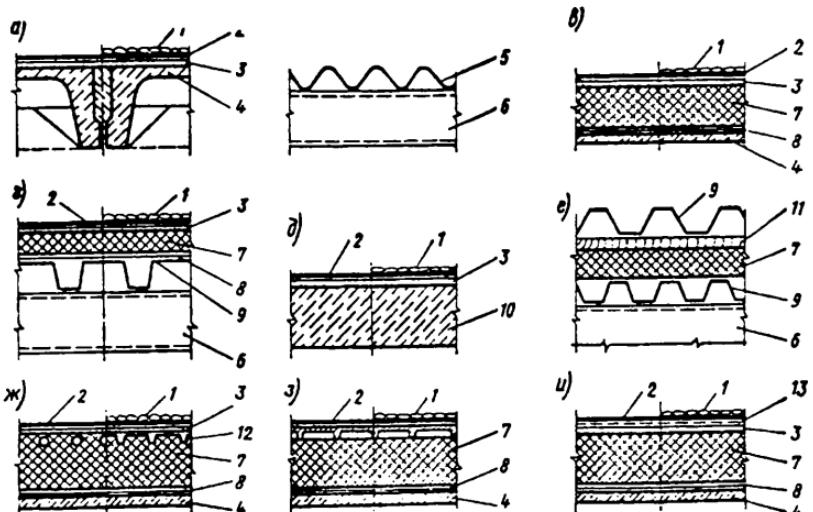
Основные типы кровельных покрытий промышленных зданий (детали разрезов):
